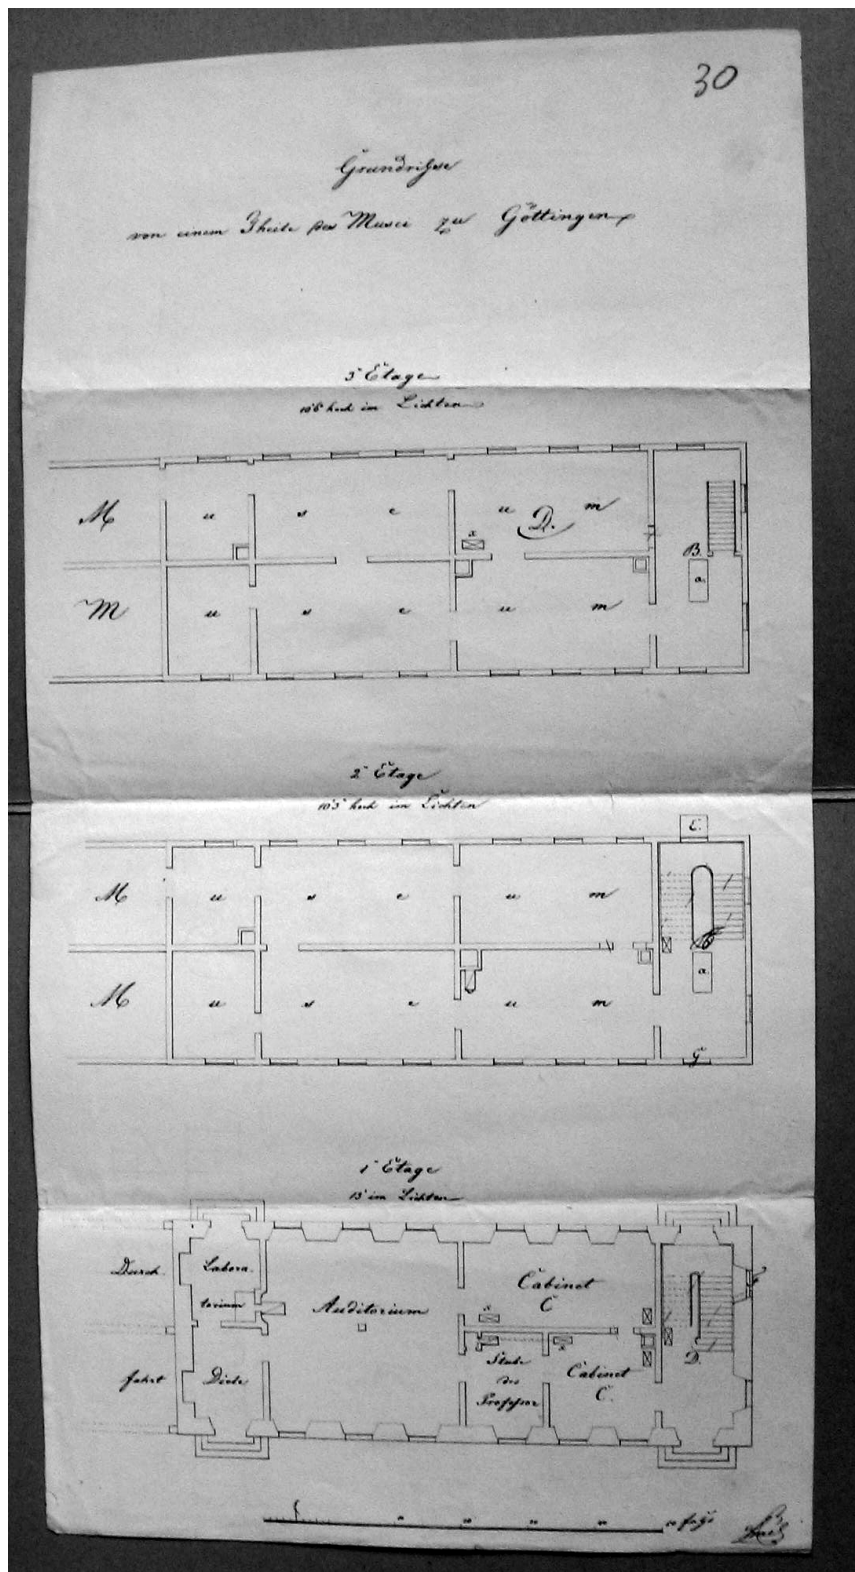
„Grundrisse von einem Theile des Musei des zu Göttingen.“ UAG Kur 4.V.h.15 Plan auf fol. 30. Das Physikalische Kabinett ist im Erdgeschoss und mit einem Raum „D“ im 3. Obergeschoss untergebracht
